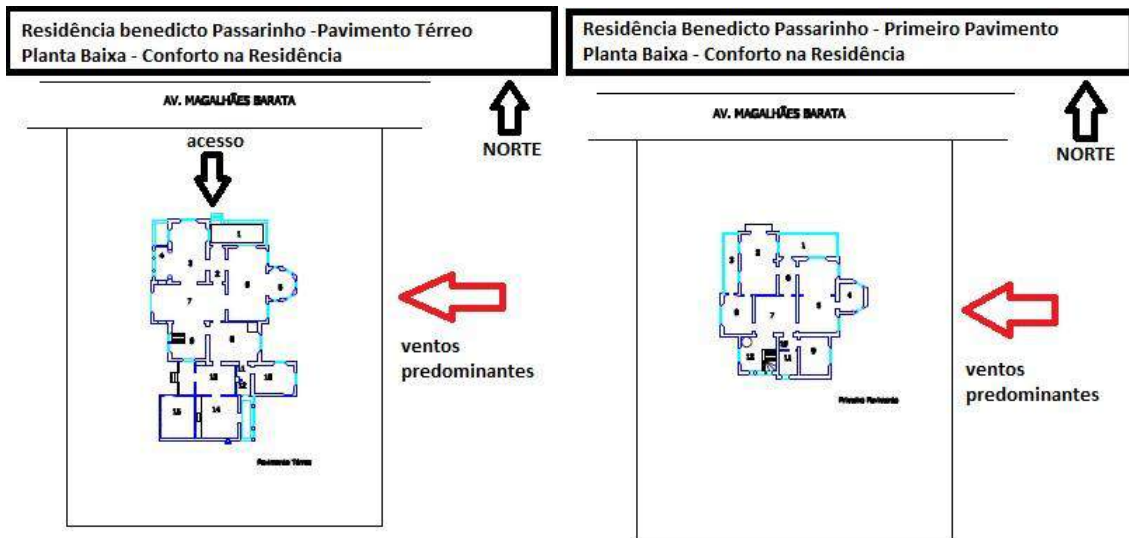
Planta de Conforto do Pavimento Térreo e Primeiro Pavimento da Residência Benedicto Passarinho (06).
